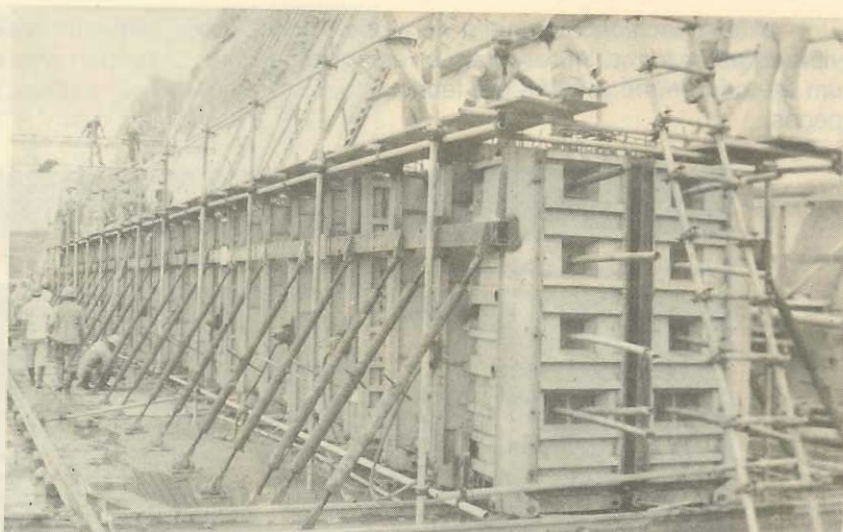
Vibradores de parede acoplados externamente à fôrma para concretagem de vigas pré-moldadas - Itaipu
